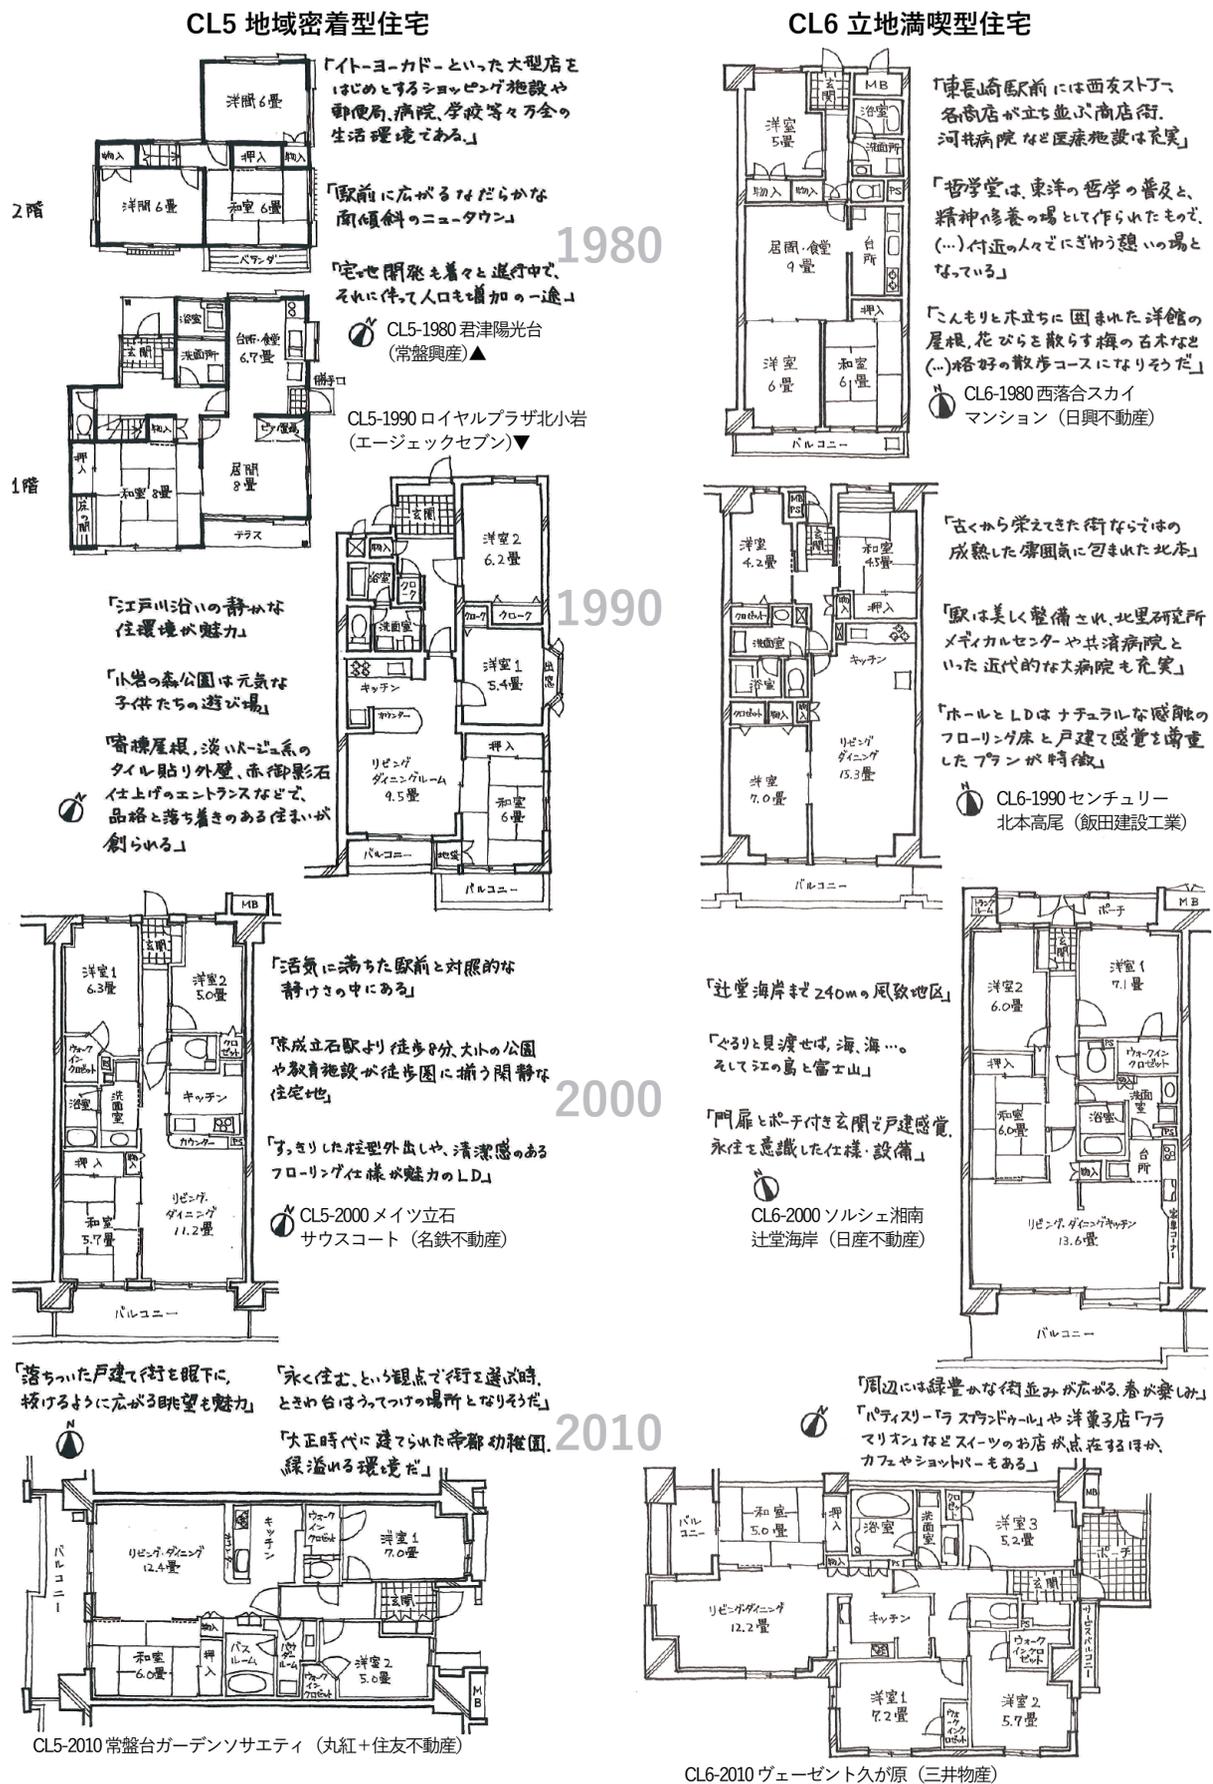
地域密着型住宅、立地満喫型住宅の平面図と住宅広告の語りの例
